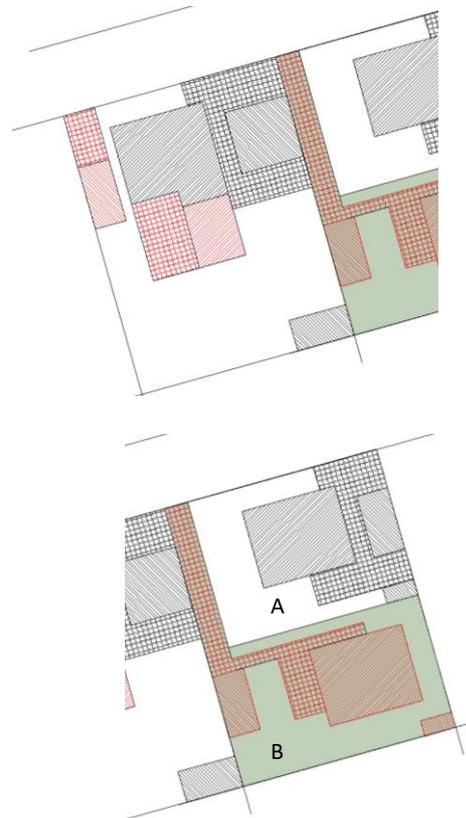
Skizze zur möglichen Nachverdichtung, schwarz = Bestand, rot= Ergänzung
